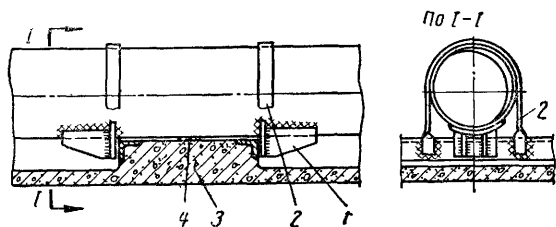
Принципиальное решение неподвижного крепления трубопроводов хомутными опорами
